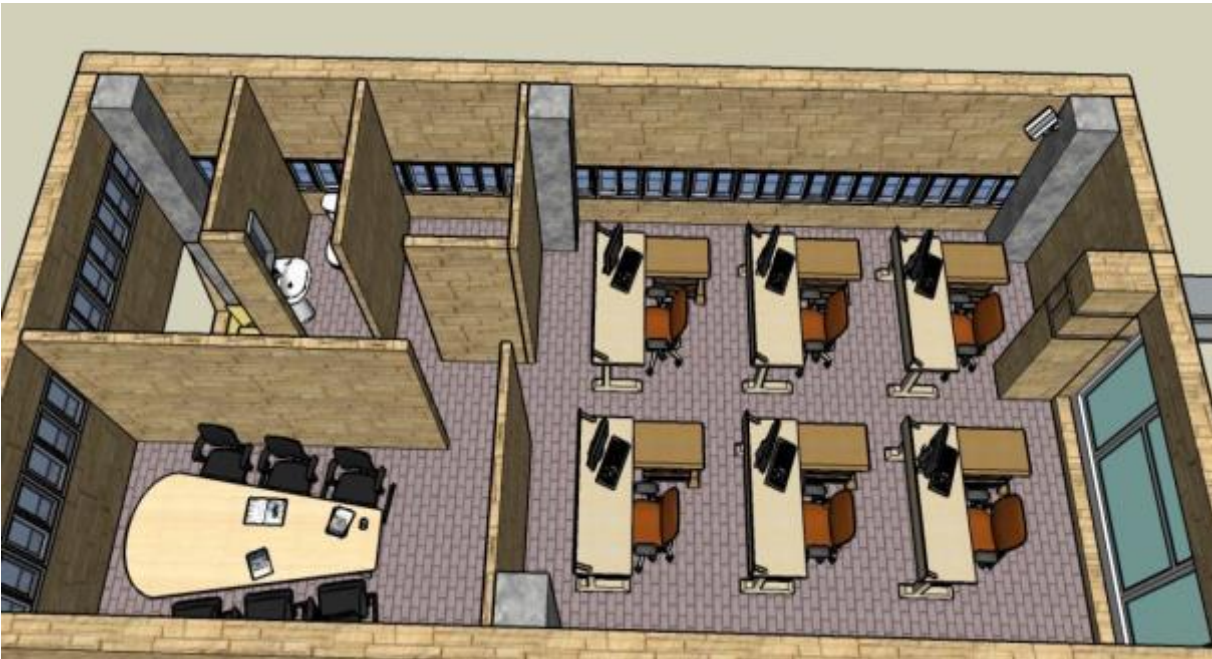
layout penerapan sistem akses pada dok kapal
